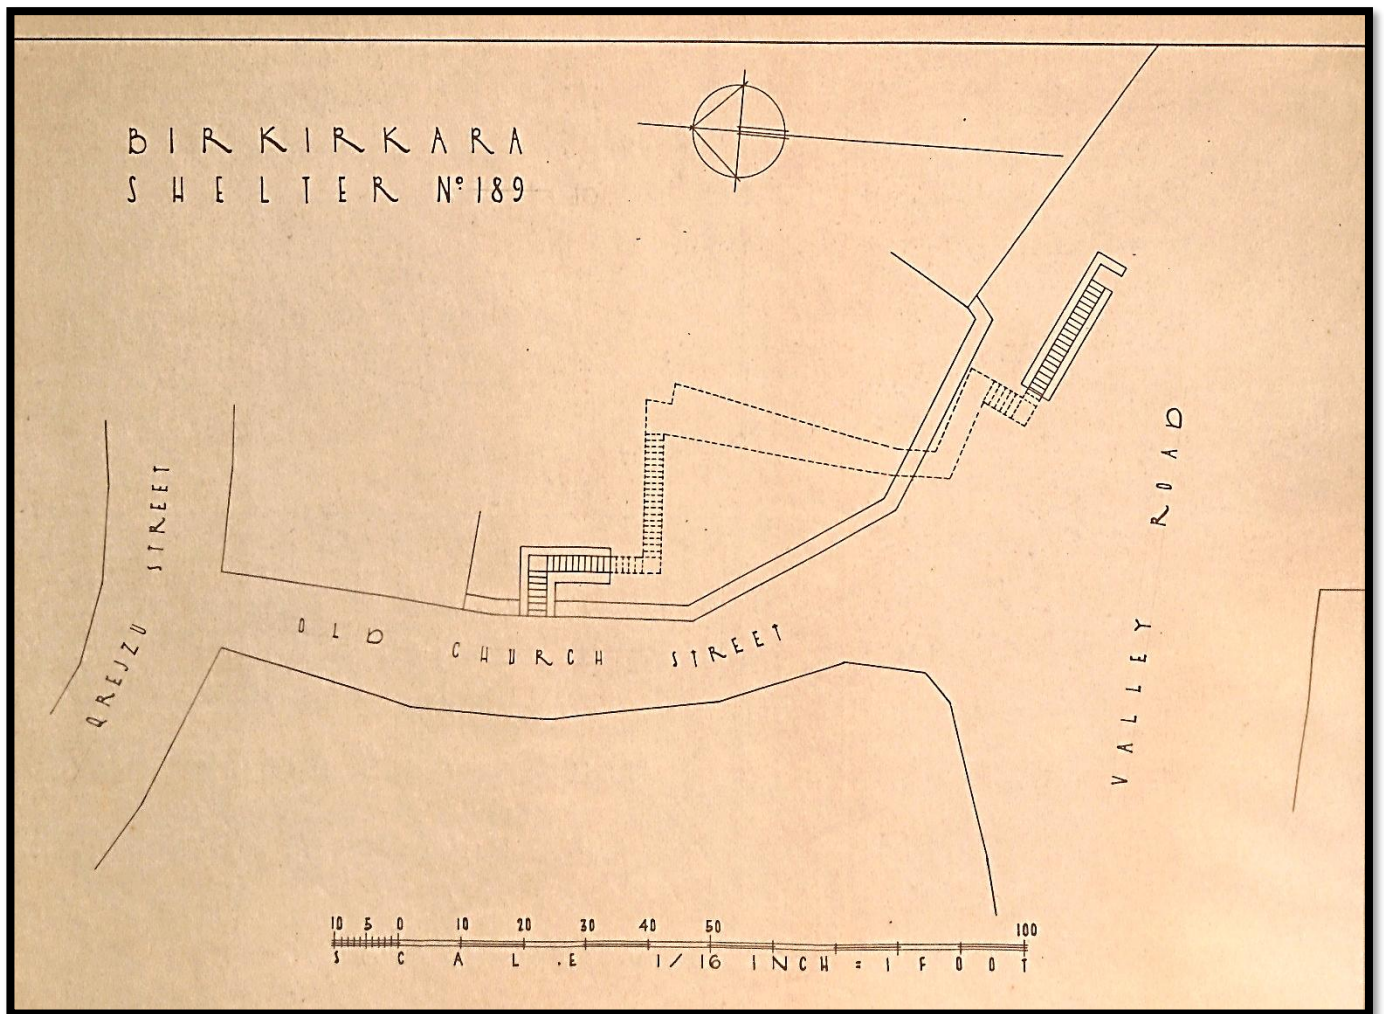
Planta do Abrigo nº 189 (10) "Qrejzu Street – Old Church Street – Valley Road."
